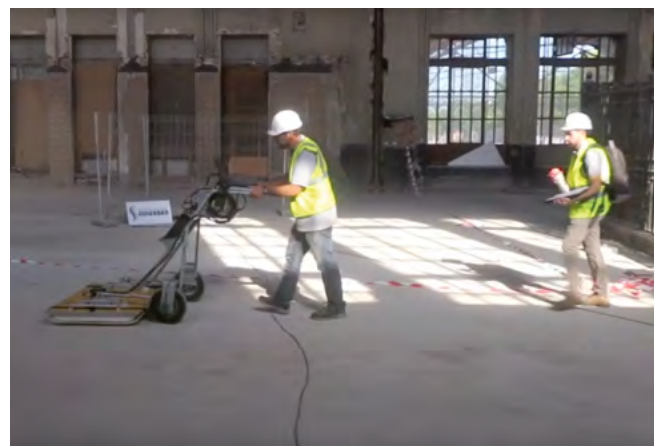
Trabajos de georradar en la planta baja de la nave central (foto: cortesía de Solorban).
